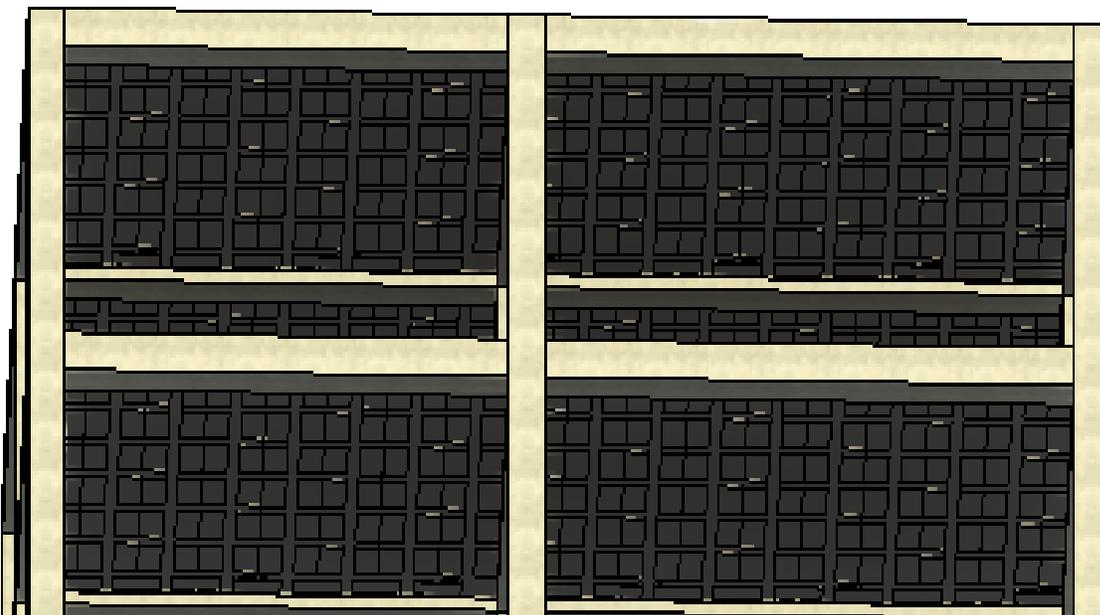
Vista inferior 3D de losa aligerada con bloque de 40x40cm
